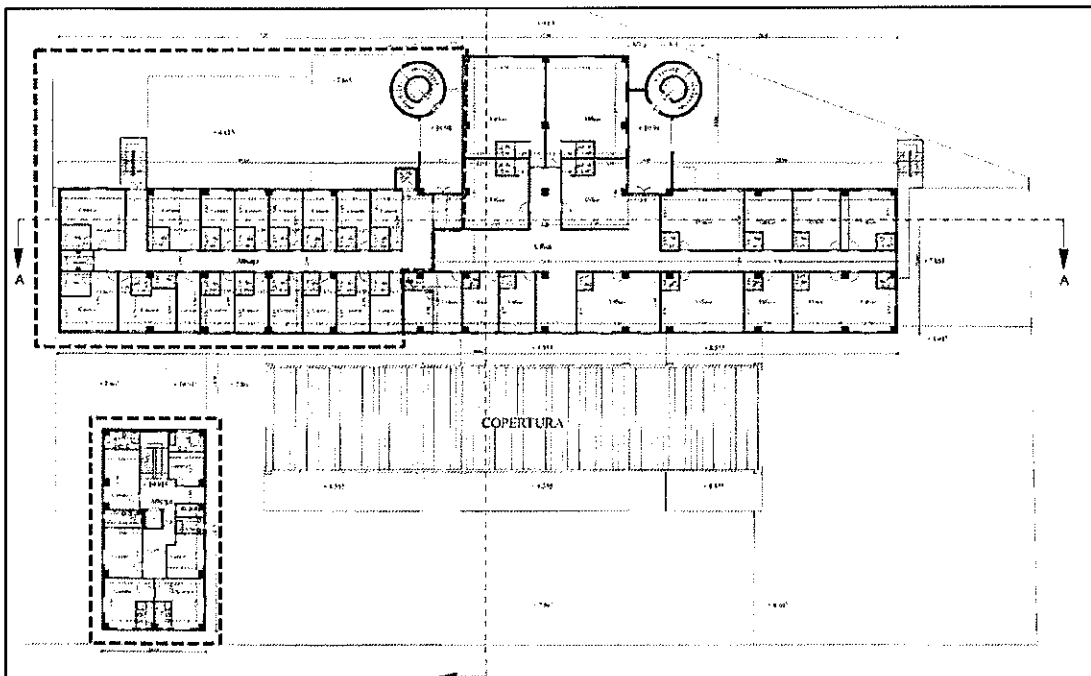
Progetto del piano secondo estratto dalla tavola allegata al PdC n. 59/2013.
